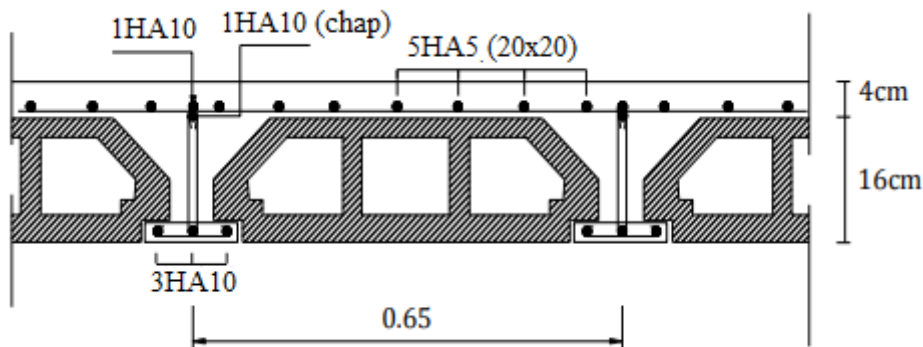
schéma Ferrailage des poutrelles aux appuis.
